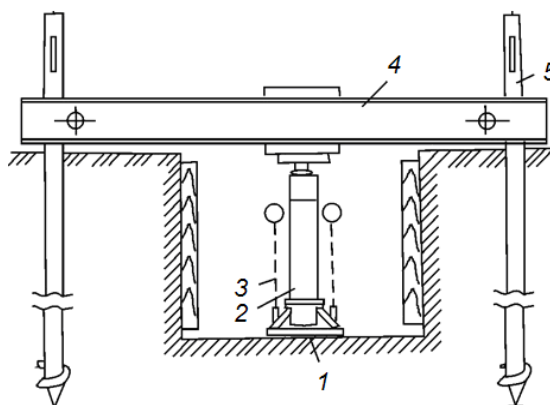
Схема испытания грунта штампом в шурфе:
